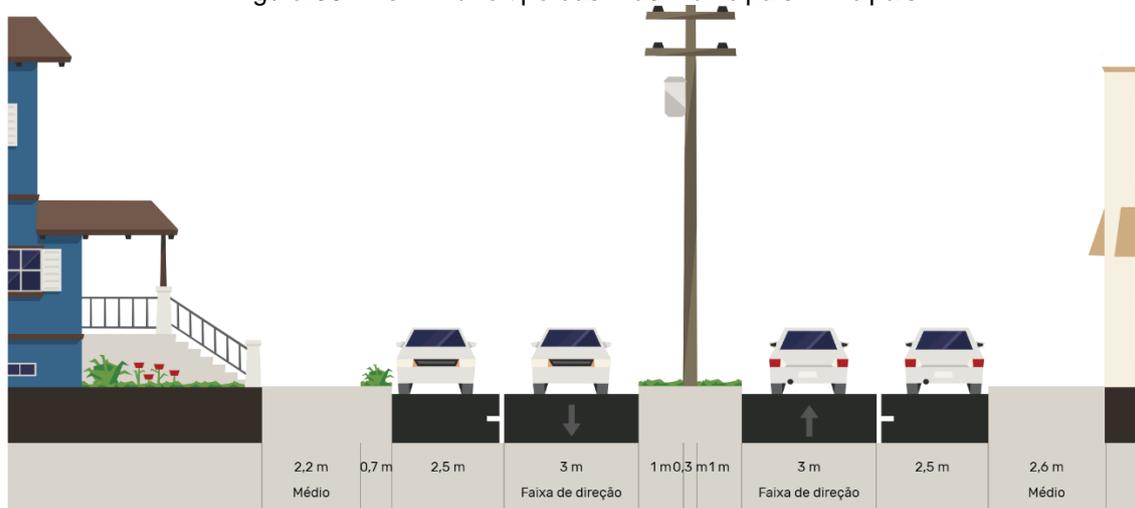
Trecho de Conexão da SC-492 entre zona urbana e rural.
